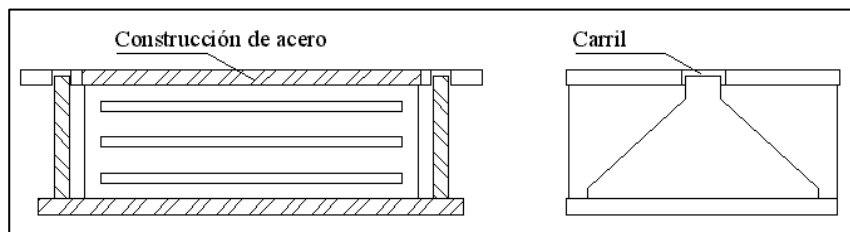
Apoyo de elastómero con construcción de acero fijo en una dirección.
